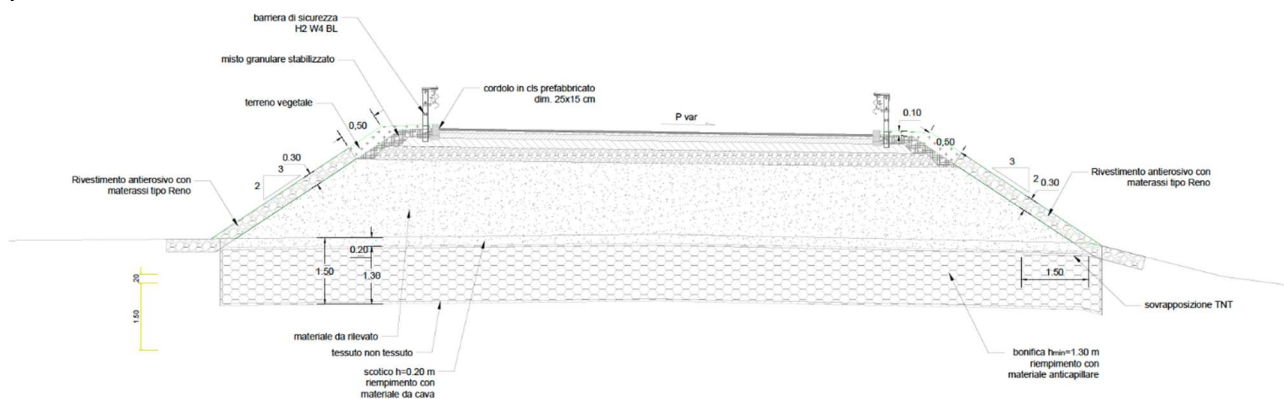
Sezioni tipo rilevato con protezione mediante rivestimento antierosivo
